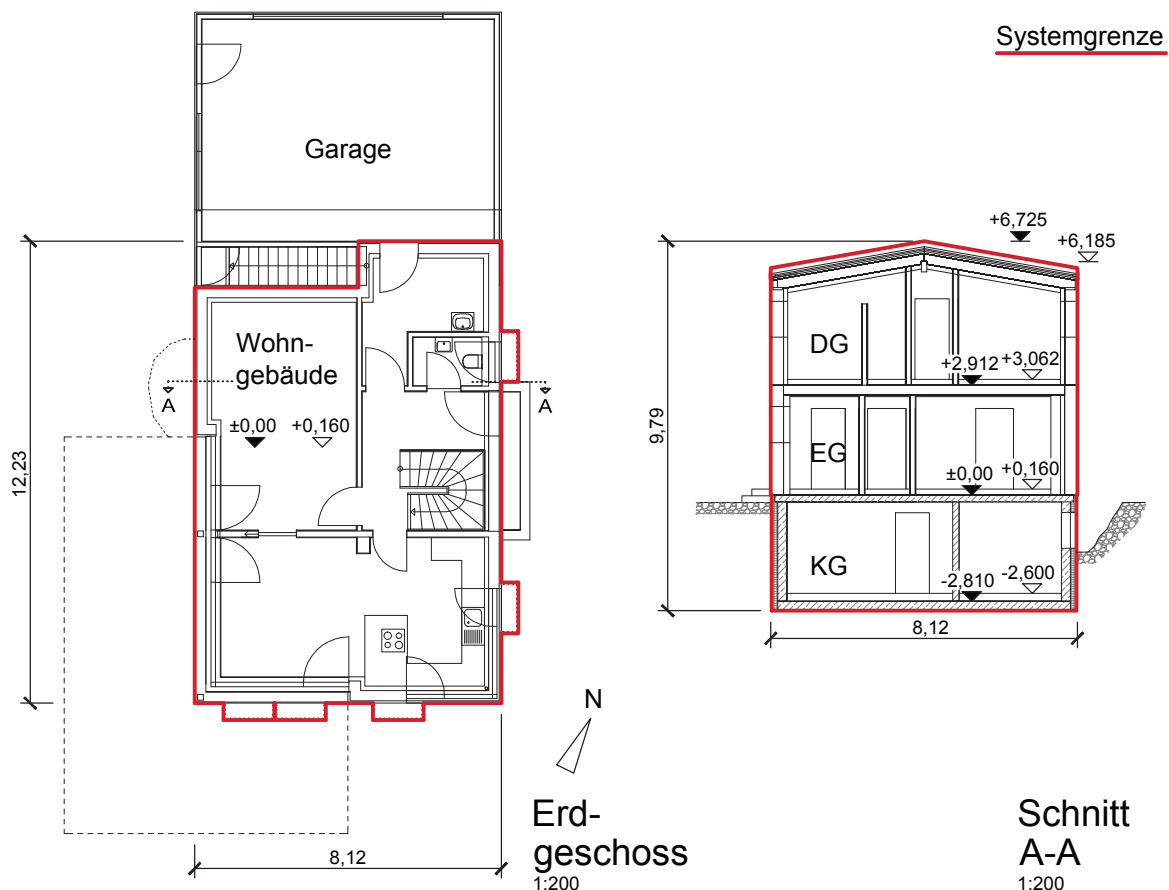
Grundriss Erdgeschoss (links) und Schnitt (rechts) des Einfamilienhauses
